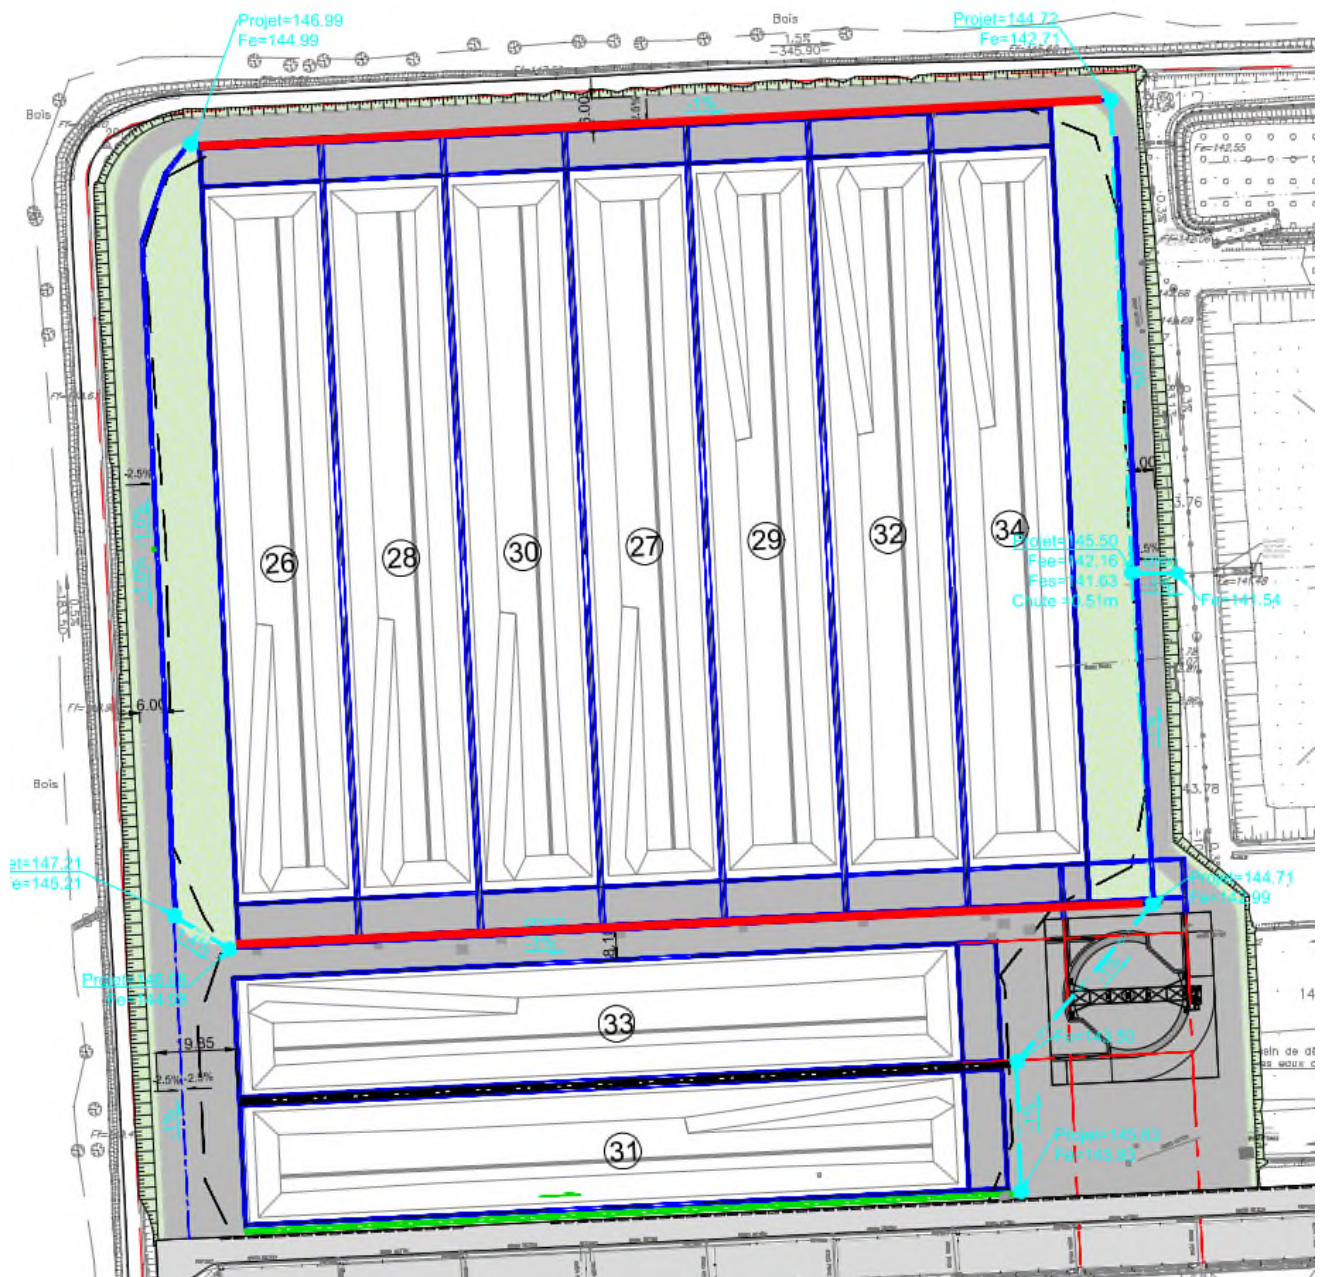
Plan de localisation des caniveaux de la tranche 3
